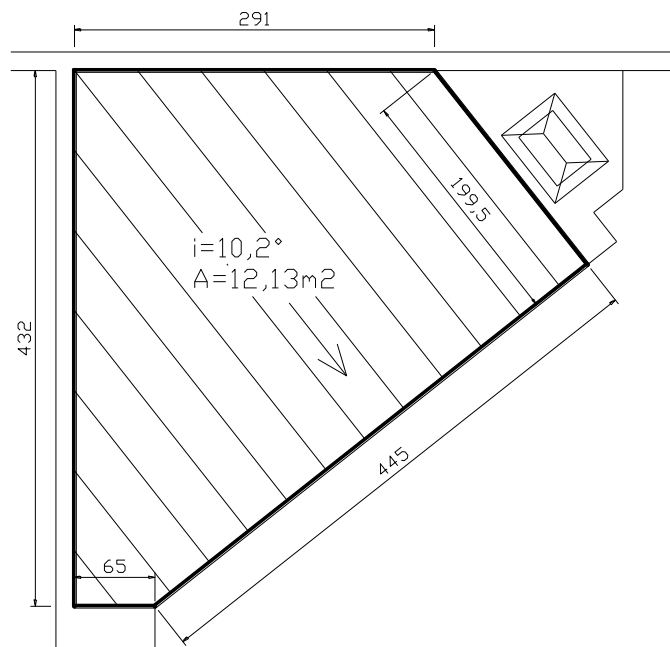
Dimensões, área e inclinação do telhado, em planta.
